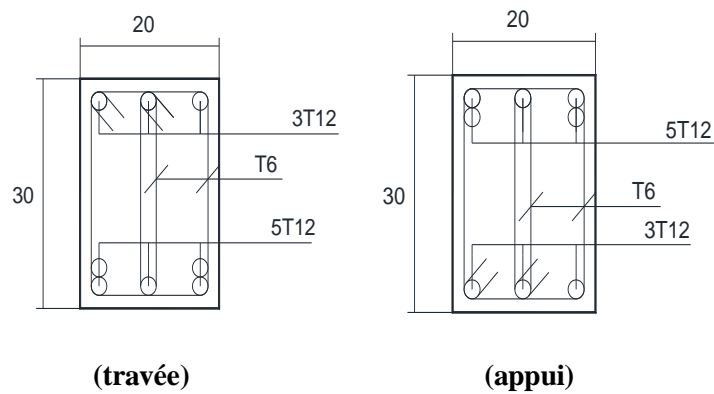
Ferrailage d'une poutre secondaire 20x30cm (bâtiment R+3)
